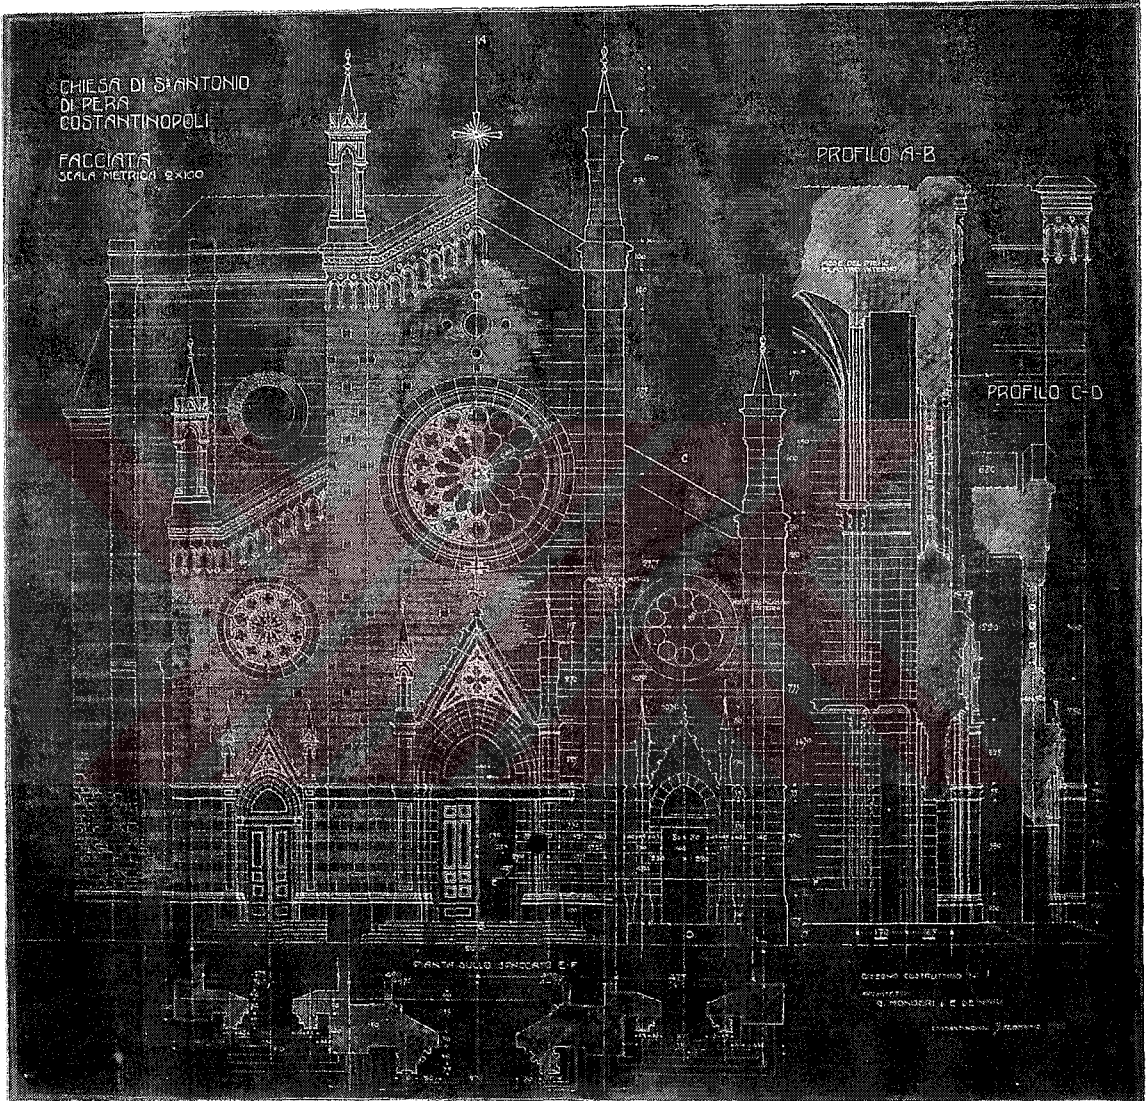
Sant' Antoine Kilisesi, temel planı ve kesiti
